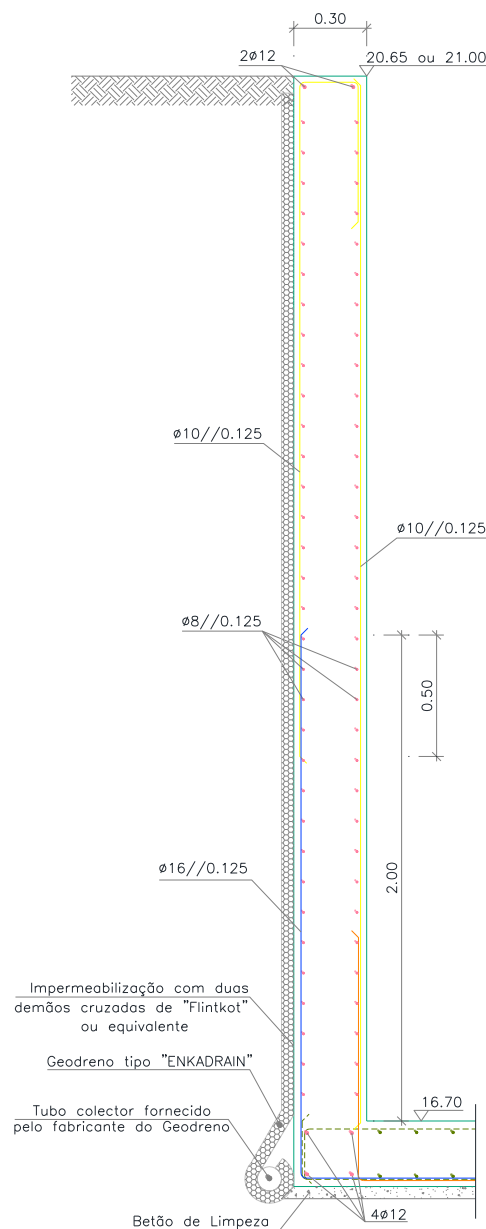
Sistema de Impermeabilização aplicado no muro MS1.
